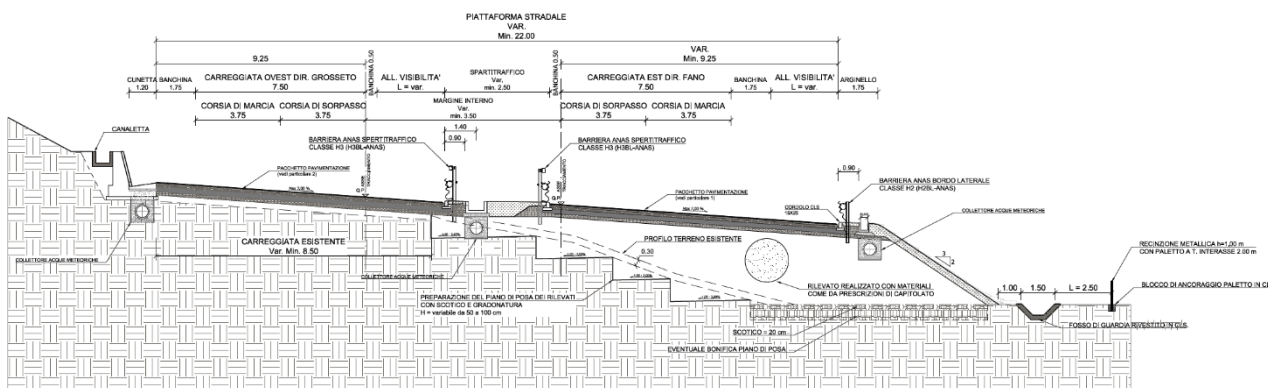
Sezione tipo a mezzacosta in rettilineo con muro a margine
